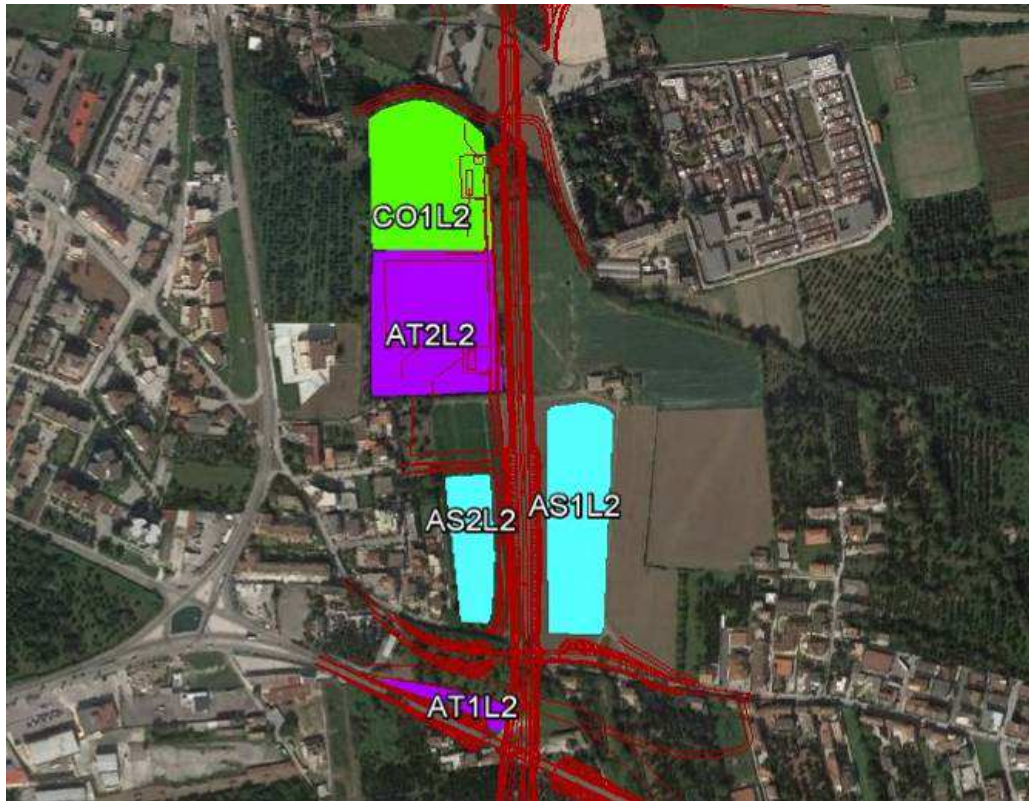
Ubicazione cantiere AT.1.L2 e AT.2.L2
